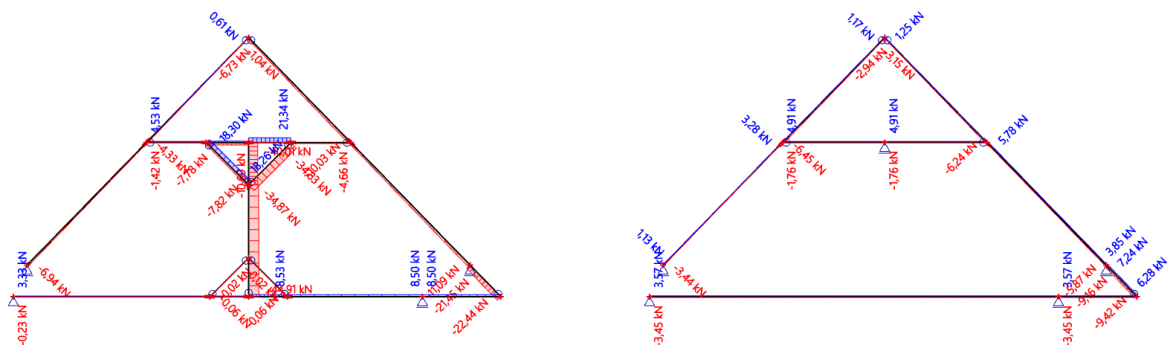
Zatížení ZS2 krokve – varianta 2
